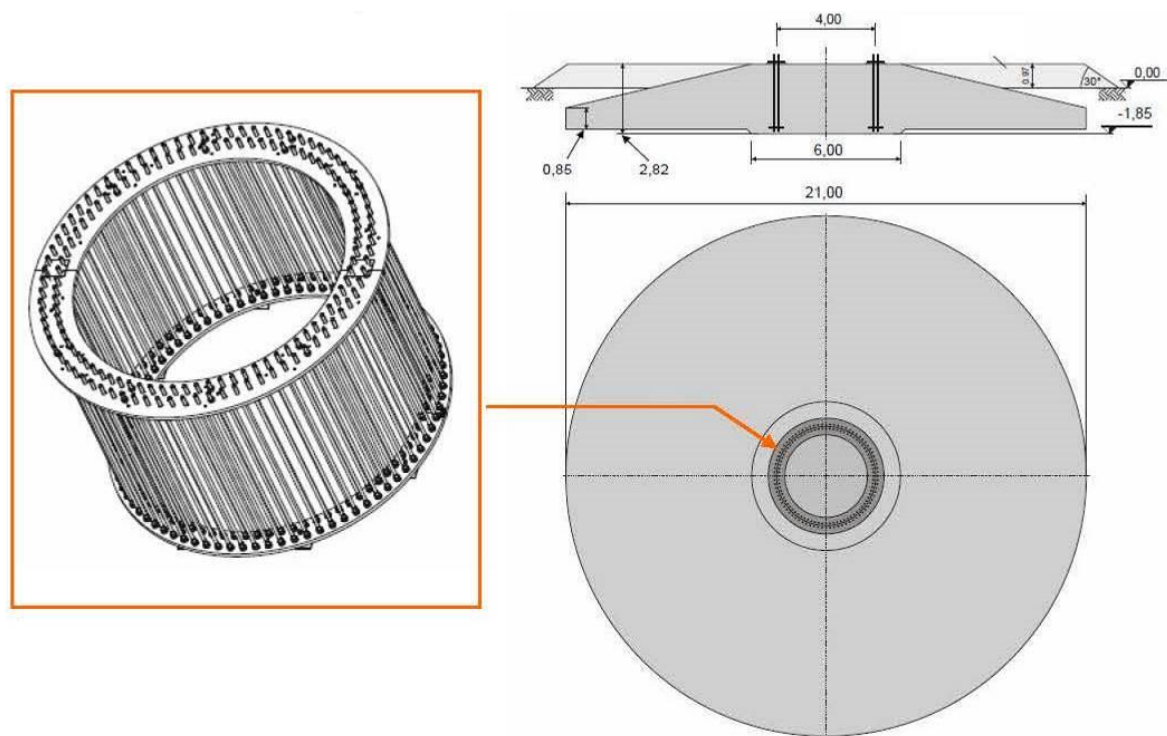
Schéma d'une fondation et de l'« anchor cage »
